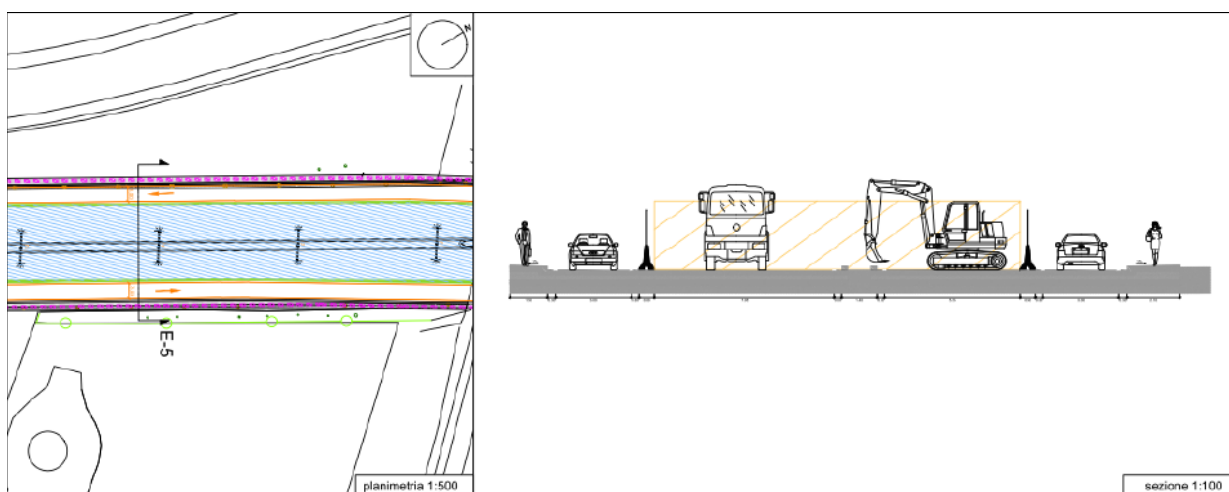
Tipologico cantiere con sede centrale Fase 3
